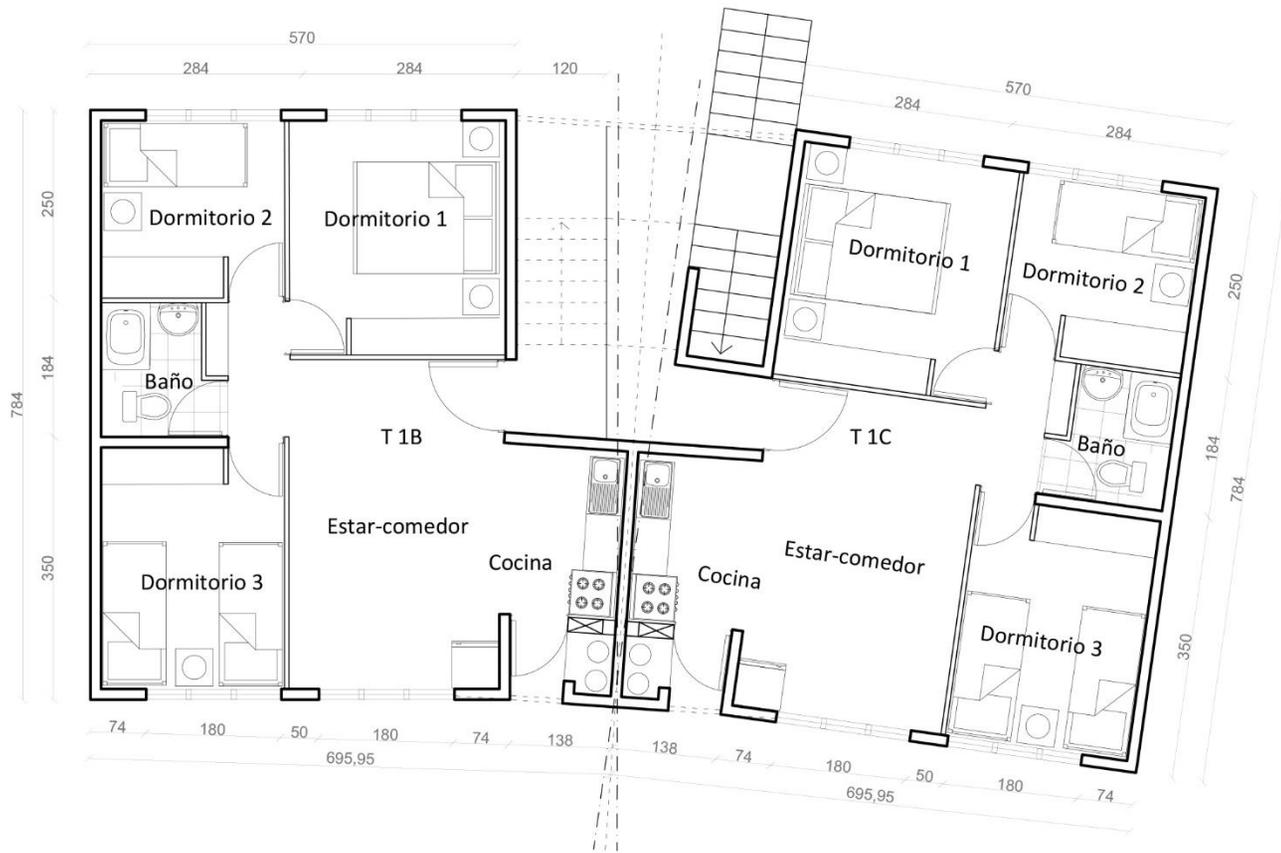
Planta piso tipología 1B y 1C Lo Ermita, esc. 1:100. Fuente: Elaboración propia
